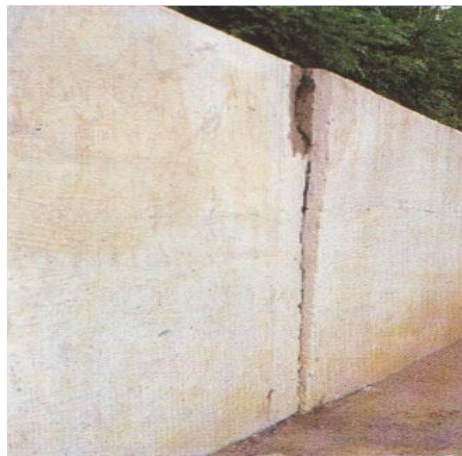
Vista de la distorsión del muro de concreto de un cerco perimétrico.
